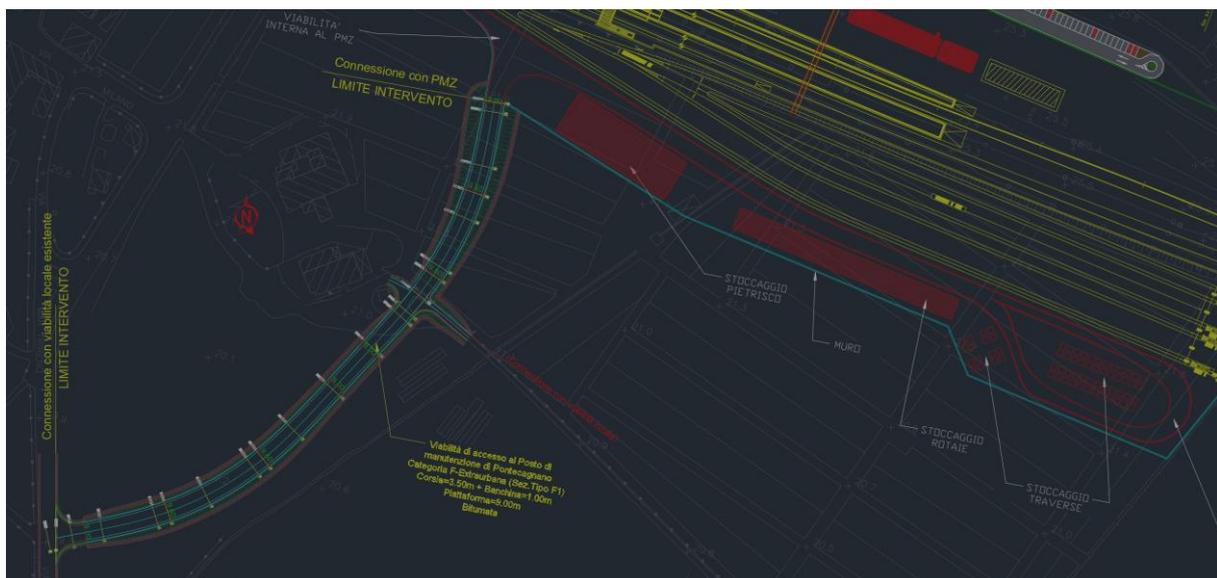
Stralcio planimetrico – NV07\_Viabilità di accesso al PMZ di Pontecagnano
